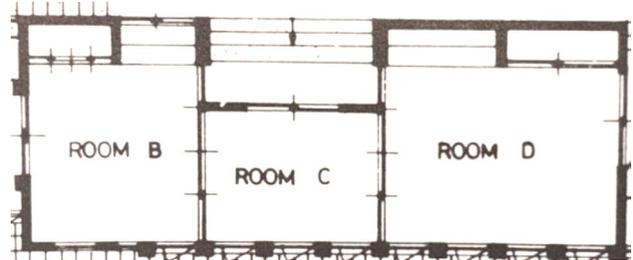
：ヨドコウ迎賓館三階の和室三室続き平面図
